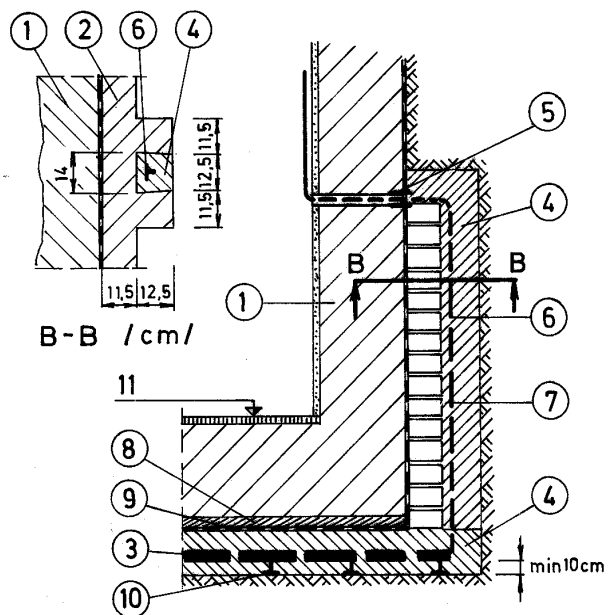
Извођење уземљивача у темељу од армираног бетона
